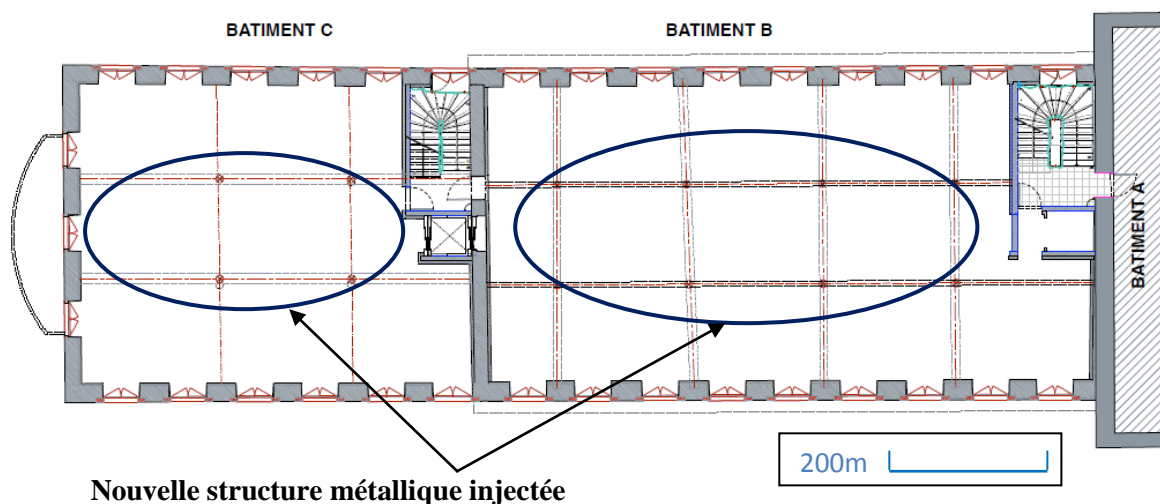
Plan des sous sol des bâtiments B et C vide avec injection de la nouvelle structure. [31]
